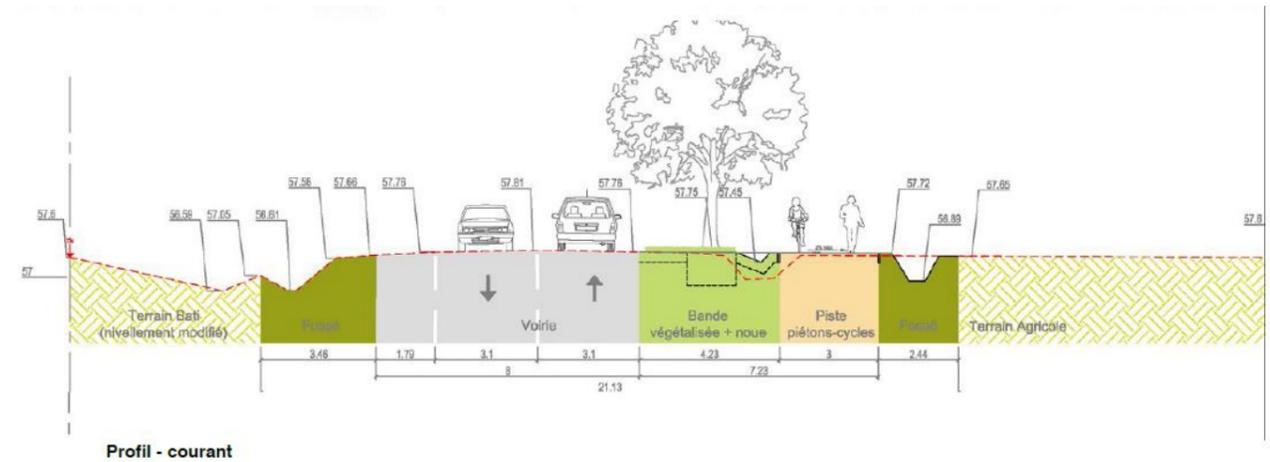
Profil courant – séquence 1 - Entre RD 403 et Avenue de la gare
